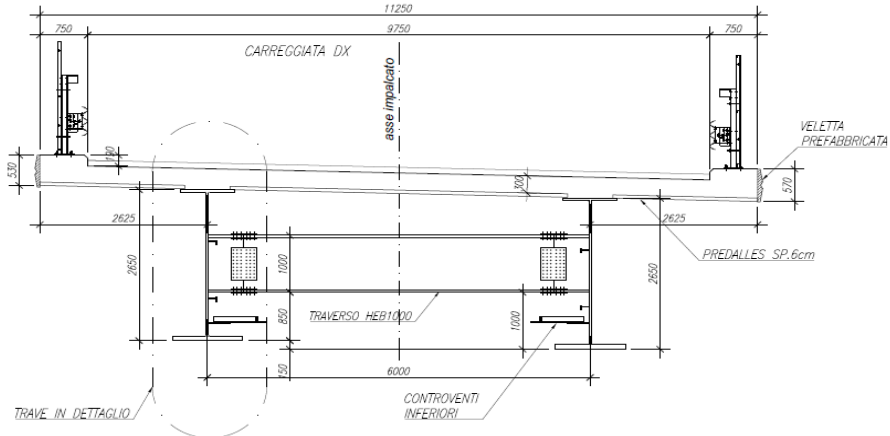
Sezione trasversale impalcato Viadotto sul fiume Ornatte
